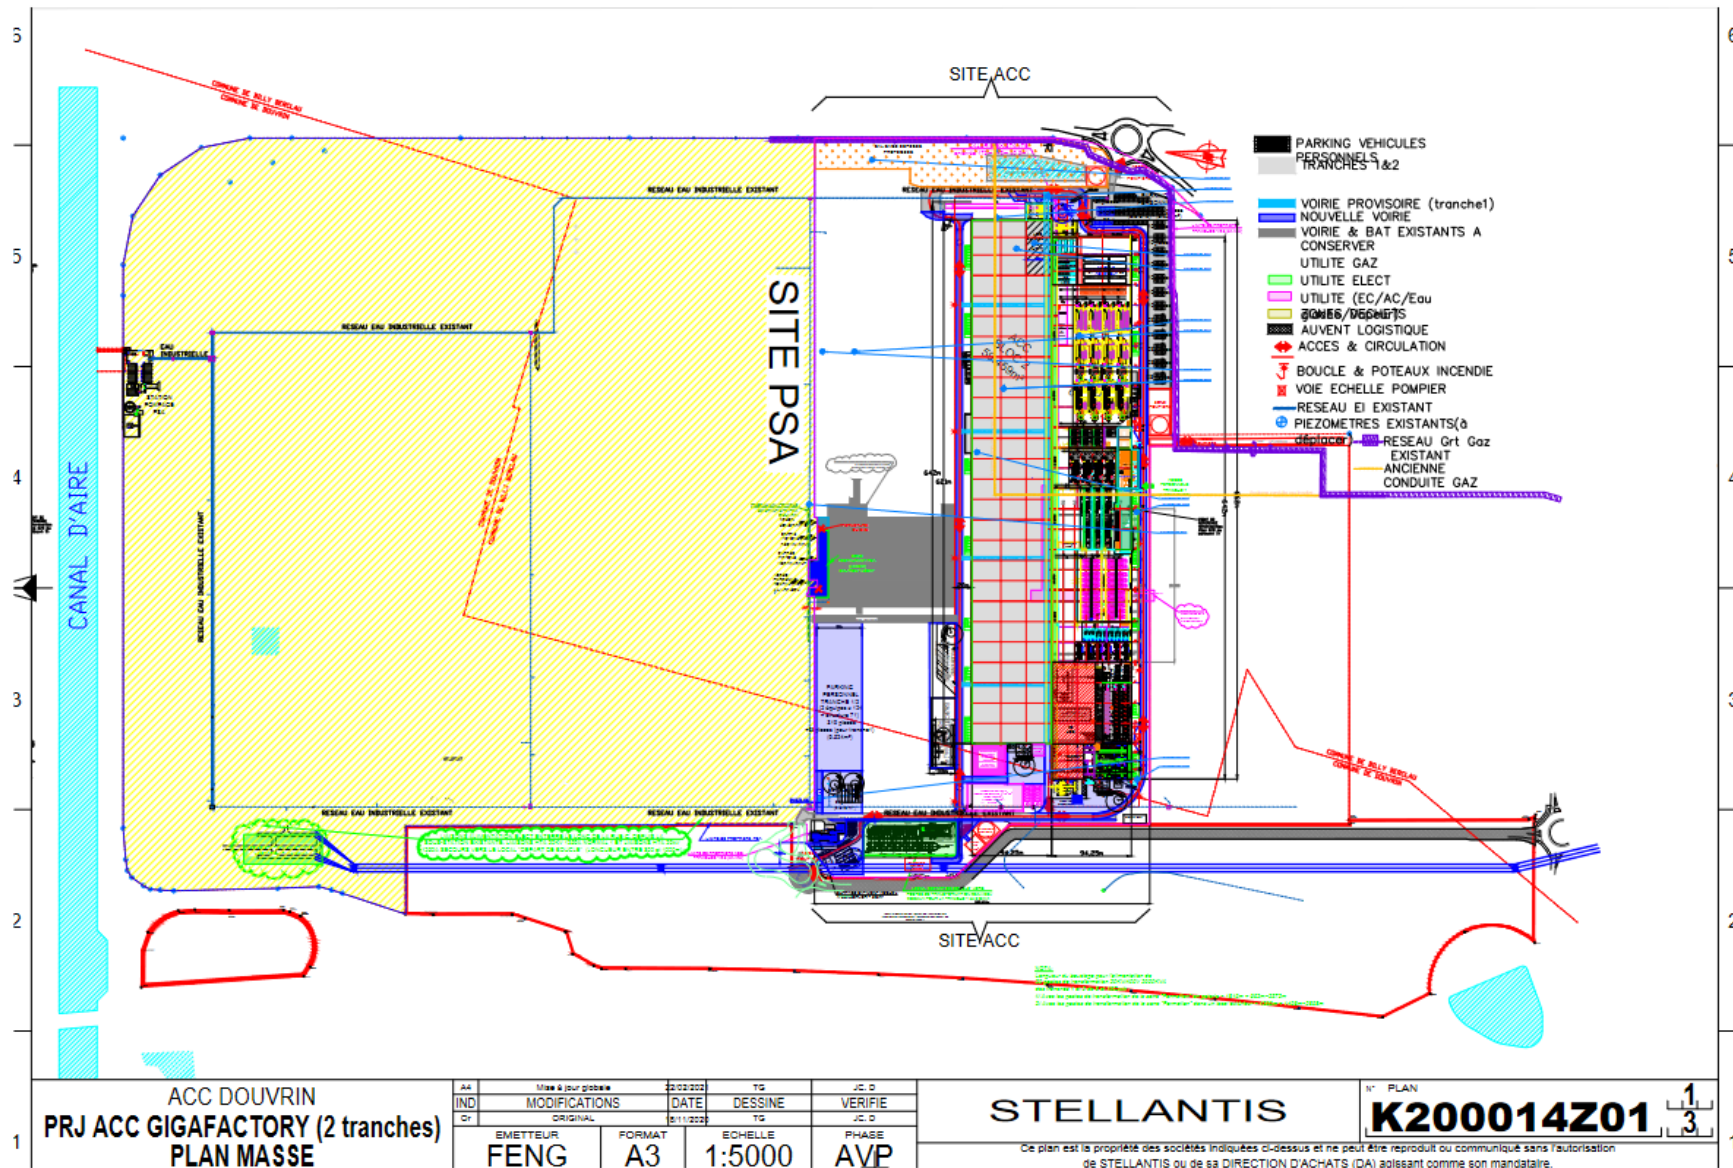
A : Plan masse des Tranches 1 et 2 (Source : PSA)
